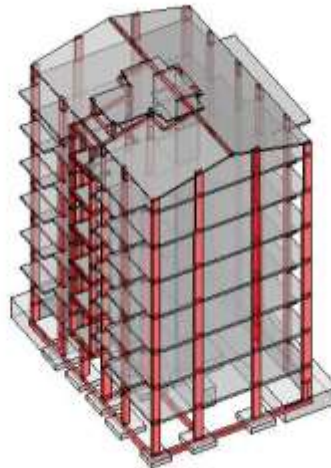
Vista alçado lateral direito projeto 3D laje fungiforme maciça
